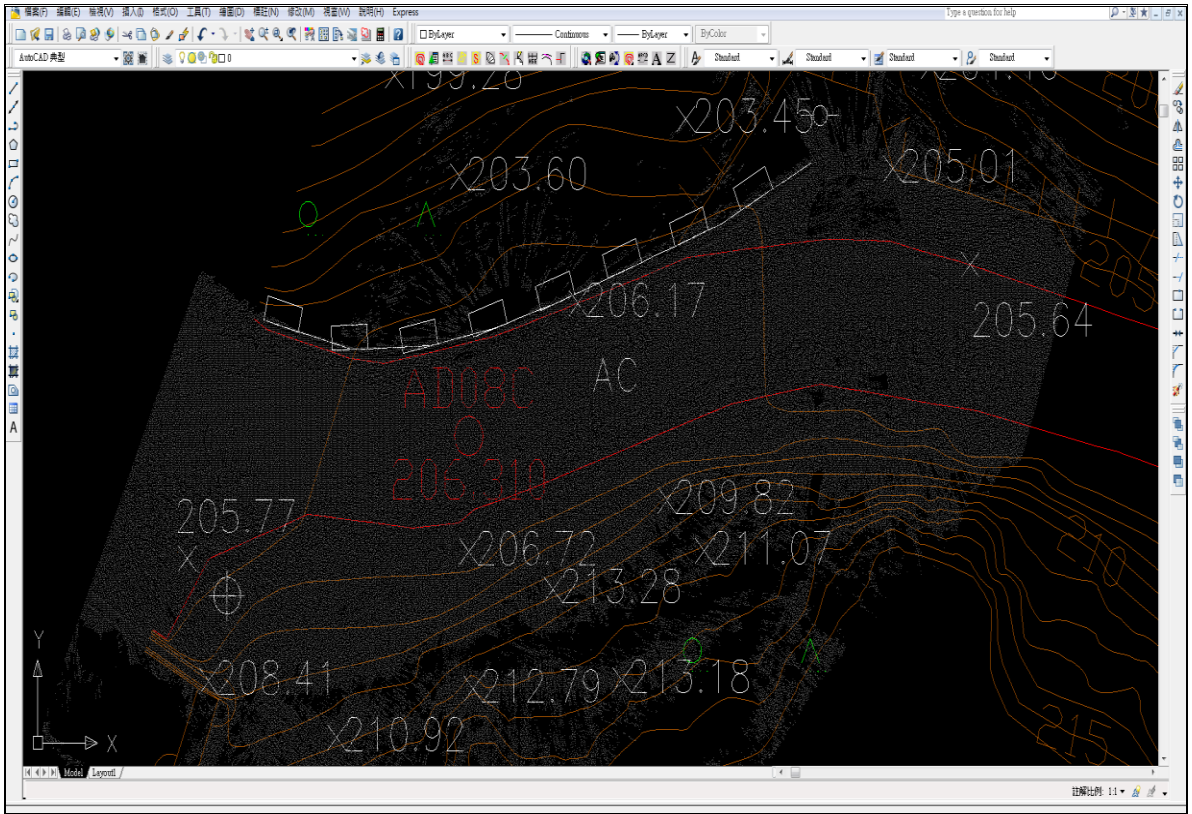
點雲資料轉繪 AutoCAD 平面圖
